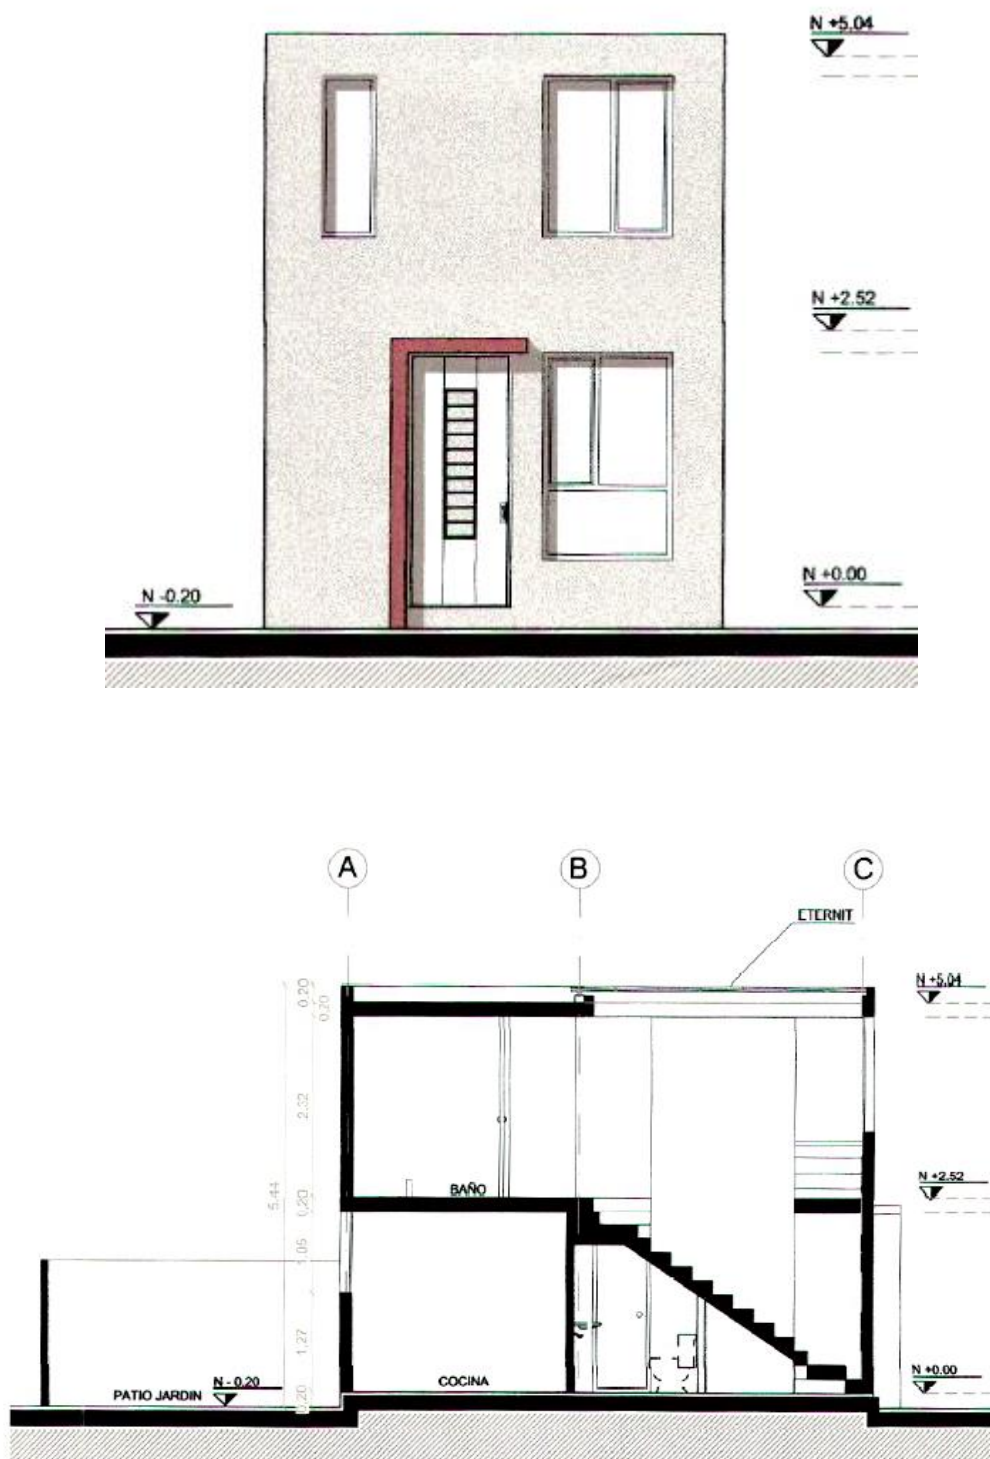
FACHADA Y CORTE. Vivienda Tipo C58SG. Proyecto Ciudad Bicentenario.
